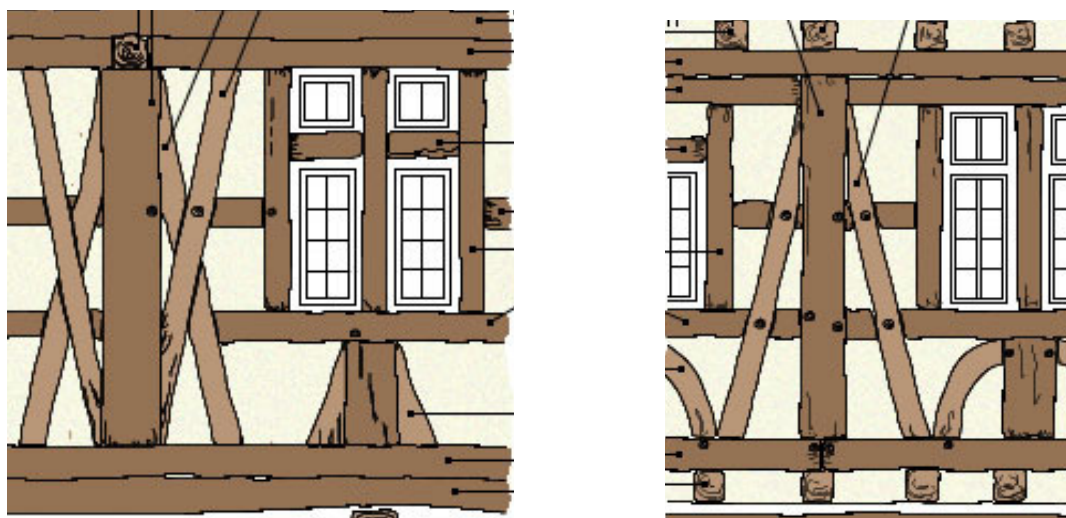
Fachadas em enxaimel. Fonte: FACHWERKHAUS (2004).
